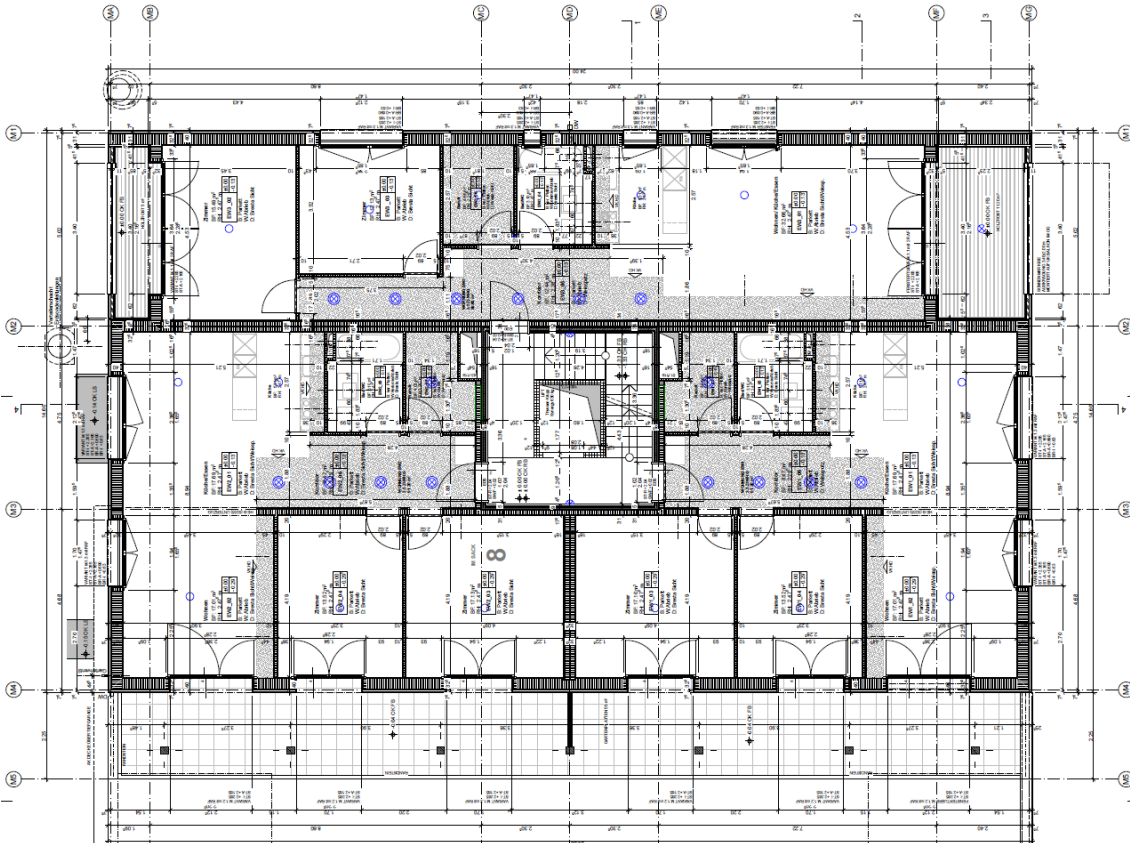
Grundriss Erdgeschoss (Bild ZBF Architekten AG)
